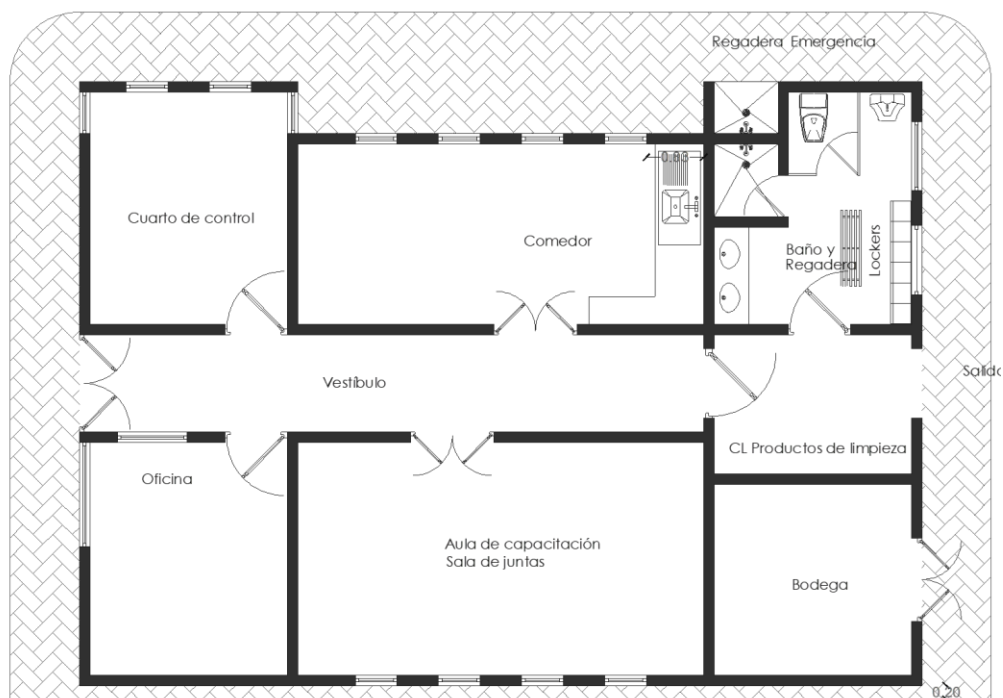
Planta Arquitectónica de la Caseta de Operación
